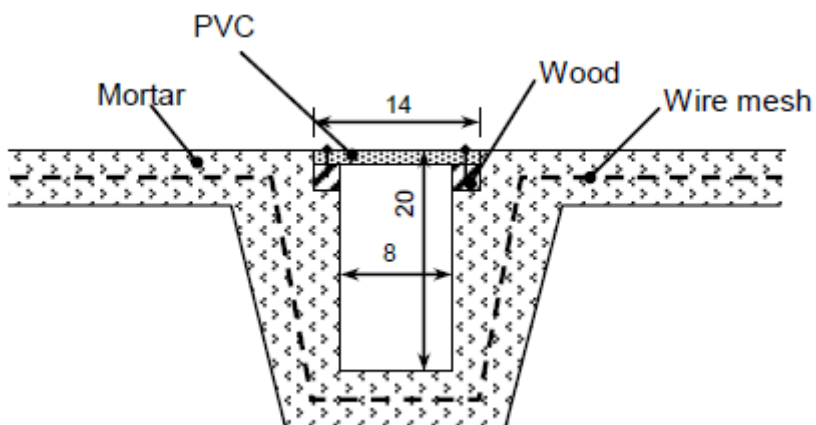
Vista transversal do canal de ondas (Sancho, SPANWAVE II).
